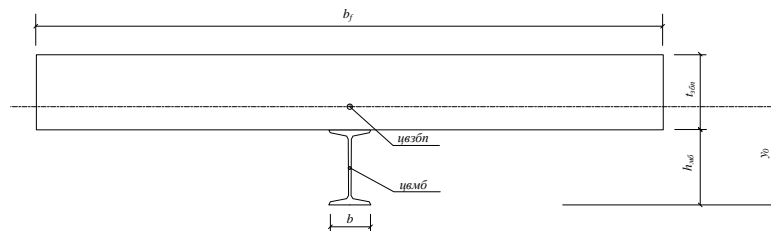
Поперечний переріз сталезалізобетонної комбінованої конструкції.
